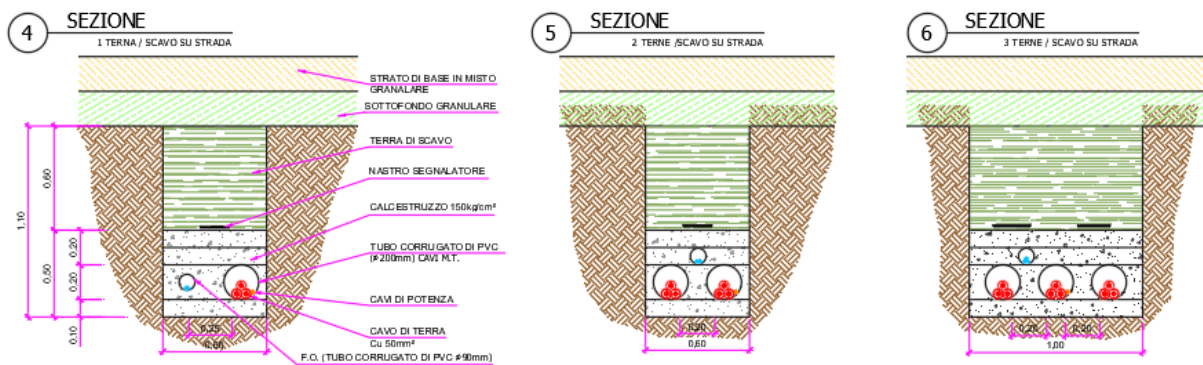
Sezione tipo di scavo su viabilità con o senza pavimentazione
